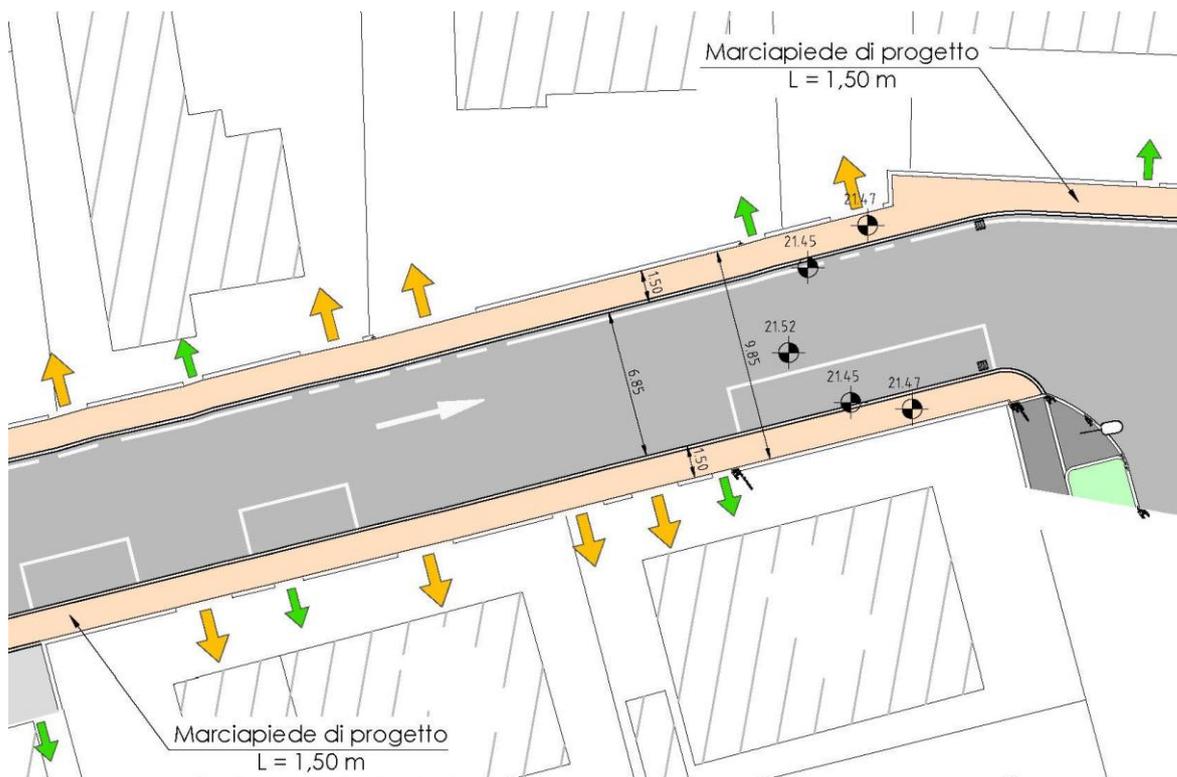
Estratto planimetria di progetto - viale Belgioioso
